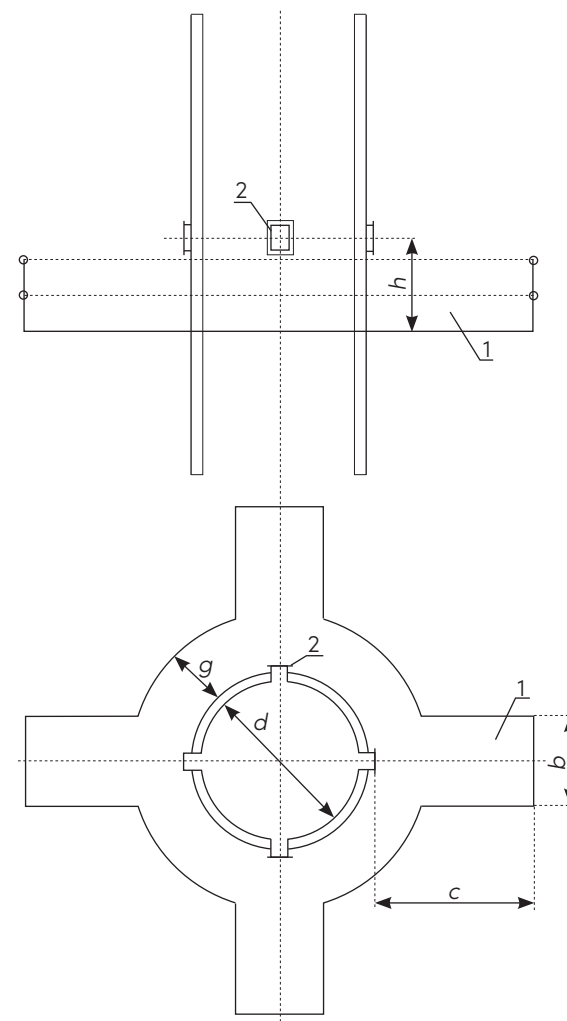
Пример рабочей платформы и размещения измерительных портов в вертикальном круглом газоходе (1 – рабочая платформа; 2 – измерительный порт; b – длина рабочей зоны; d – внутренний диаметр газохода; e – ширина рабочей зоны; g – ширина прохода между рабочими зонами; h – минимальная высота свободной зоны над рабочей платформой)
